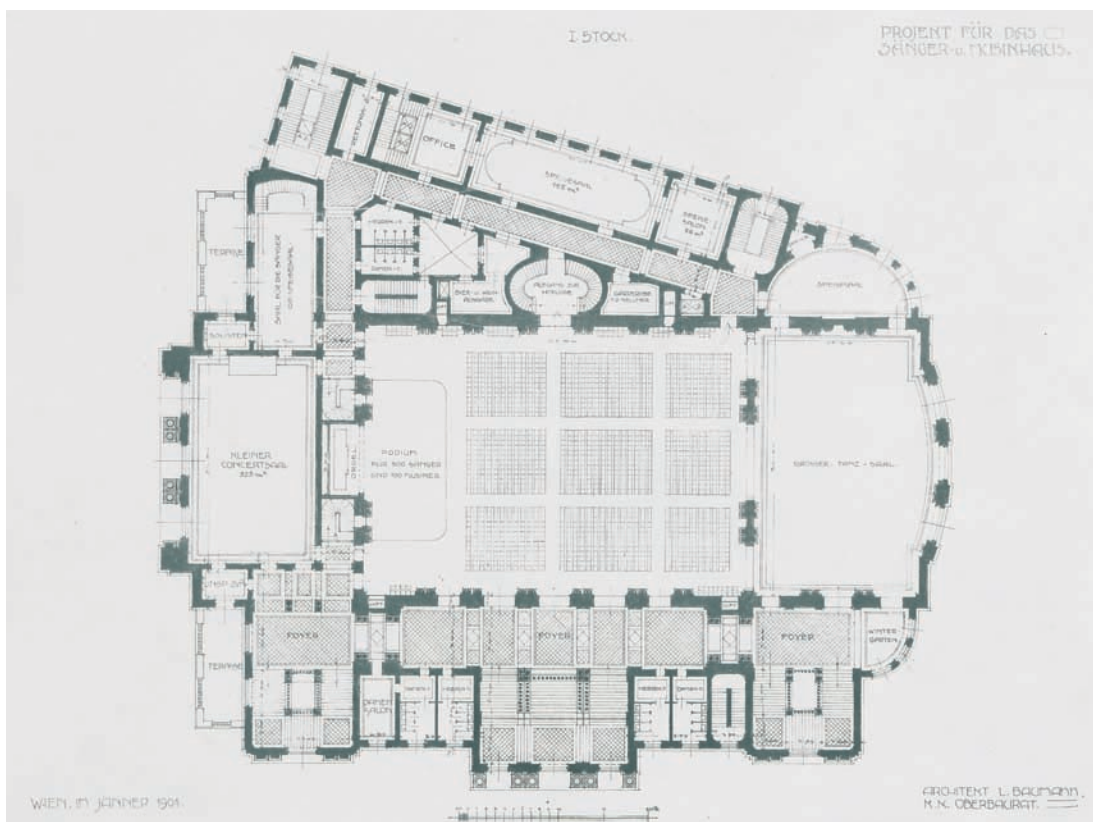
Ludwig Baumann, Projekt eines Musik- und Sängershauses, 1904, Grundriss des 1. Stocks (Wien Museum, Inv.-Nr. 238.049/14).
